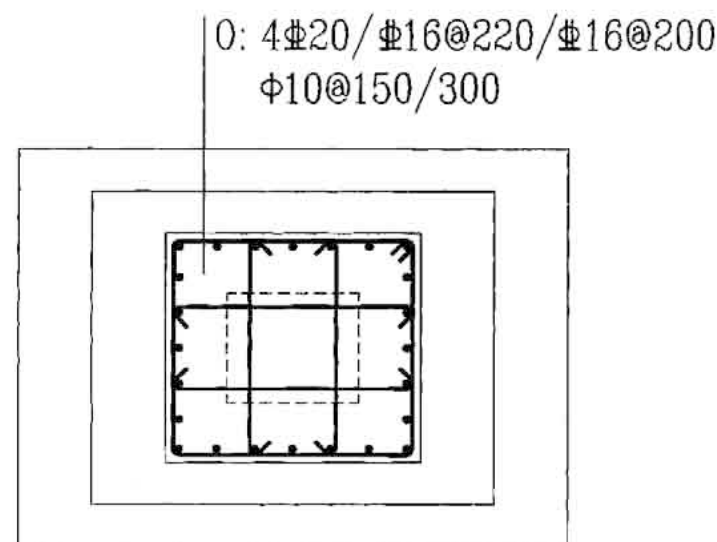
高杯口独立基础杯壁配筋示意
